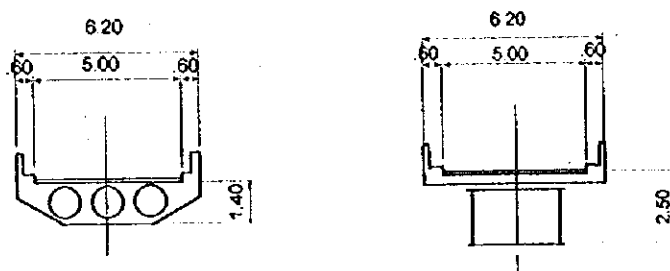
Sección Típica de Superestructura en la Intersección
